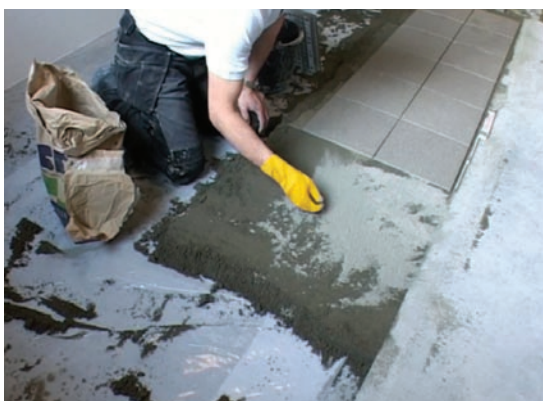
Saupoudrage de ciment sec sur une chape fraîche.
